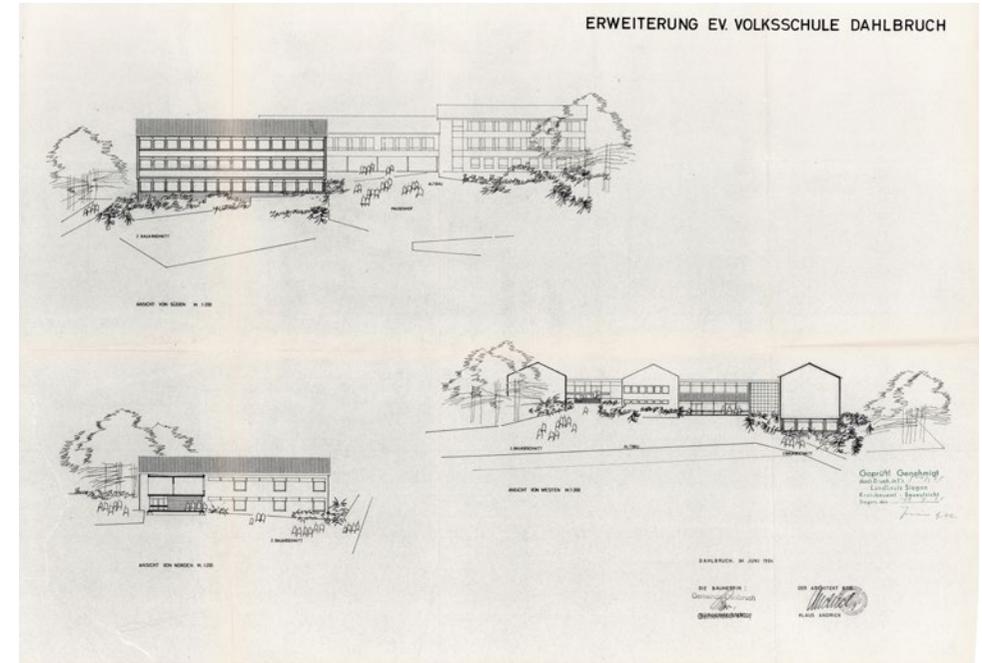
Zweiter Bauabschnitt des Schulneubaus an der Hochstraße, Plan, Klaus Andrick, Juni 1964
